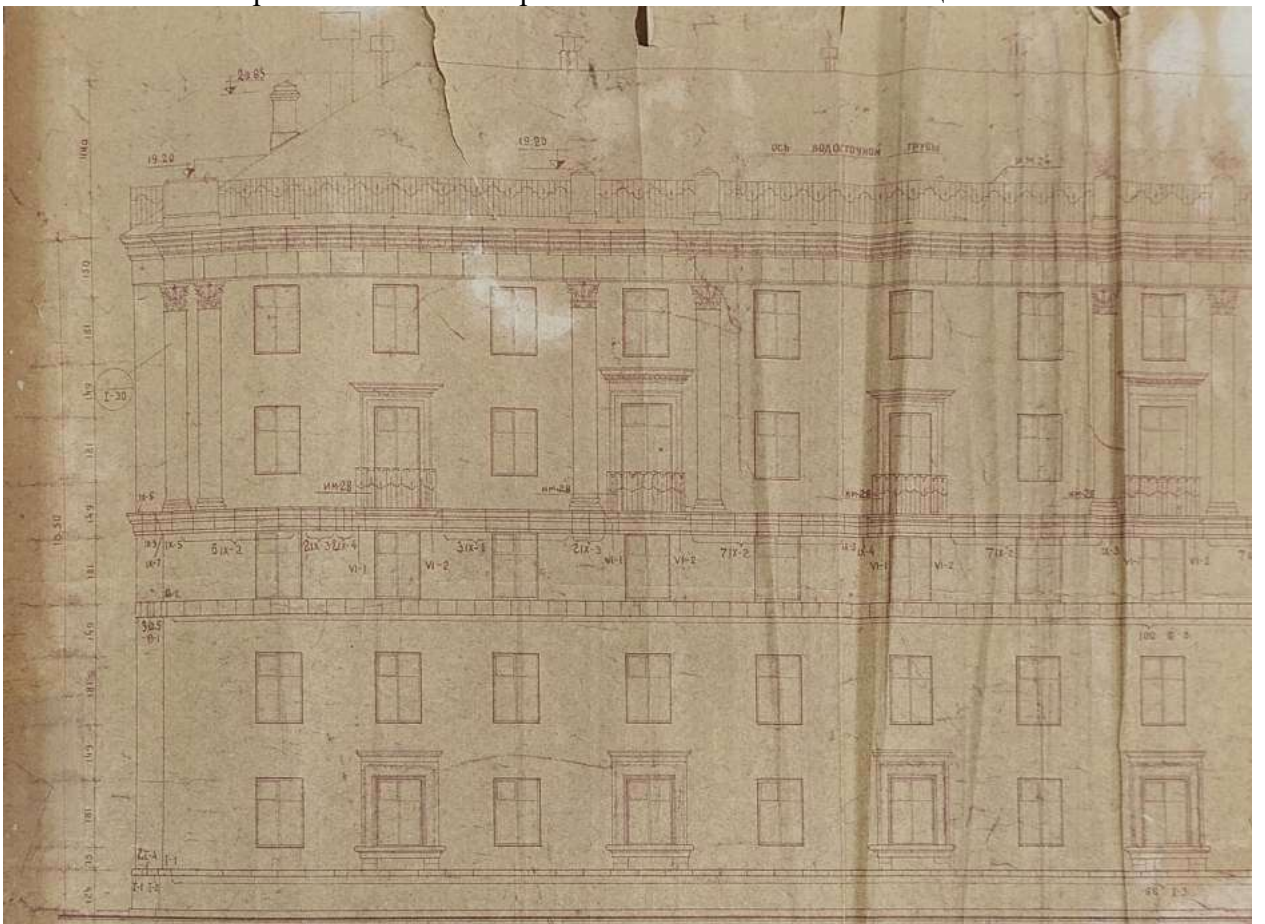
Фрагмент типового проекта № 1-409-2. Фрагмент главного фасада
